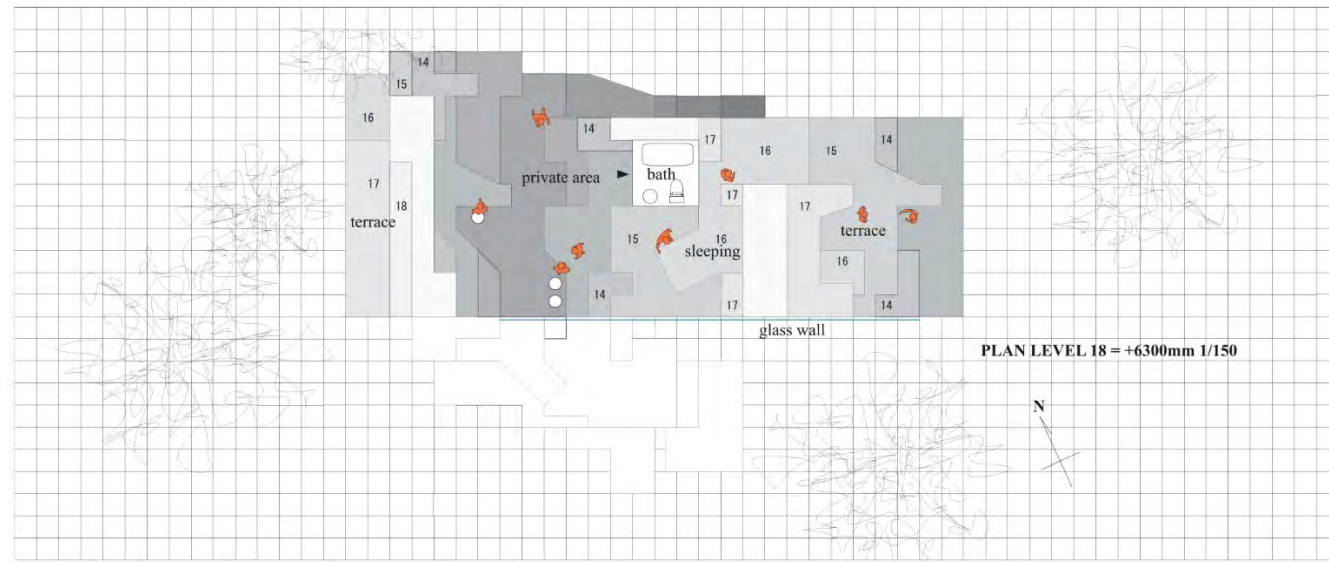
Plantas y sección de la Casa del Futuro Primitivo
